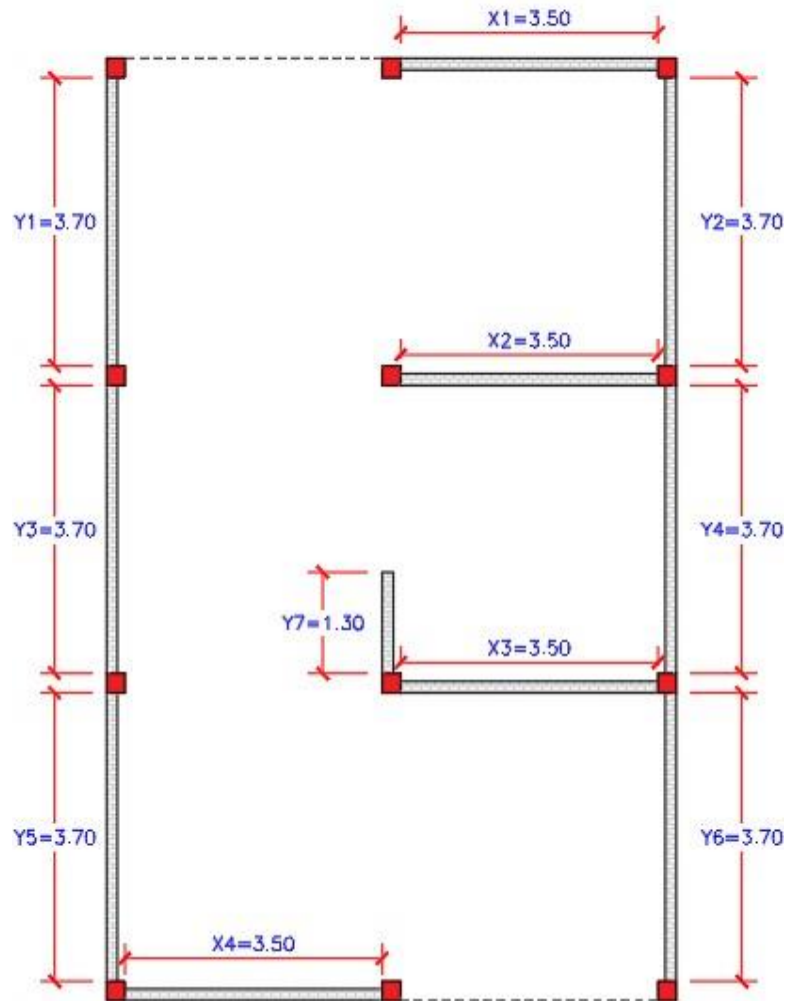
Muros portantes de Vivienda 2, vista de planta.
